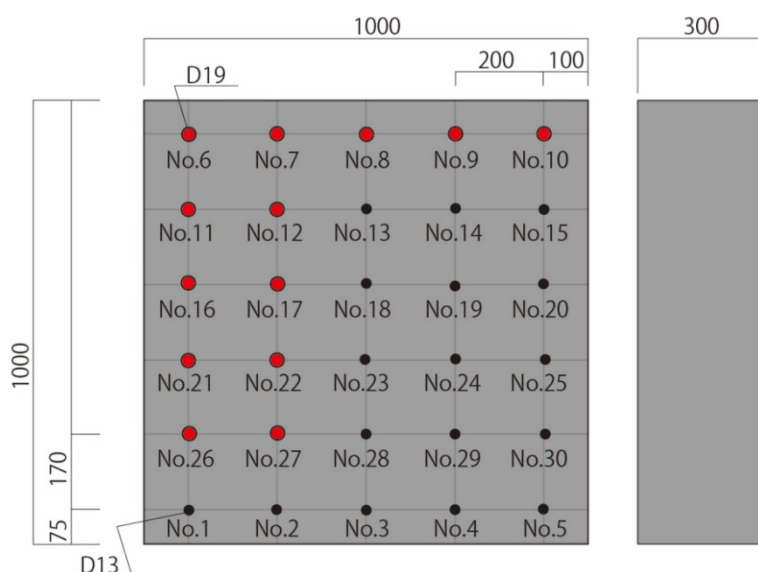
コンクリート塊試験体のアンカー筋配置 (単位 : mm)
